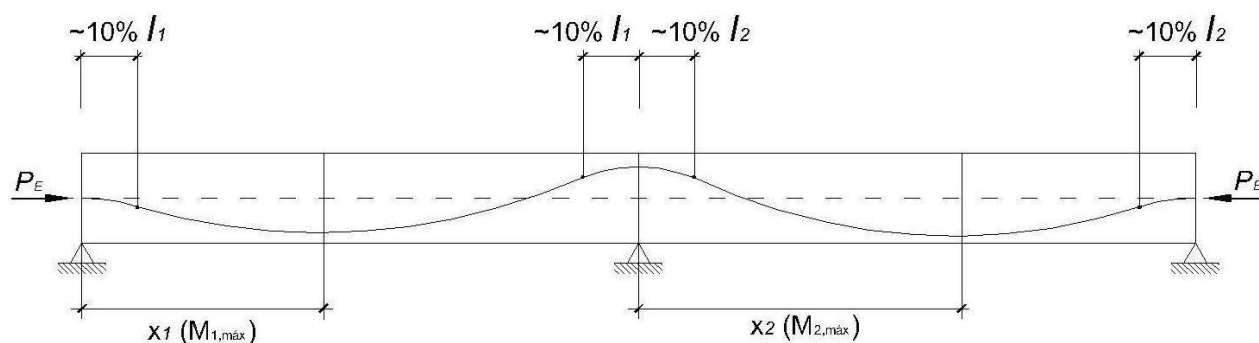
Traçado suavizado do cabo de pré-esforço 2.
